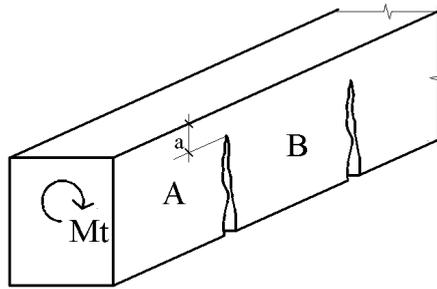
Схема железобетонного элемента с нормальными трещинами, нагруженного крутящим моментом
